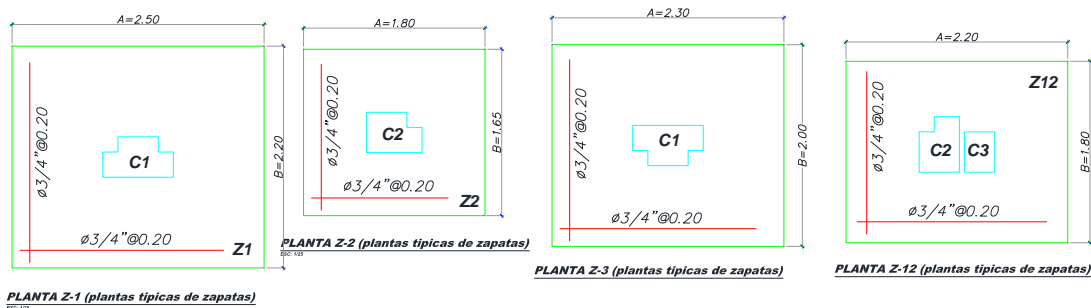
Cuadro de Zapatas y Detalle de Aligerado
